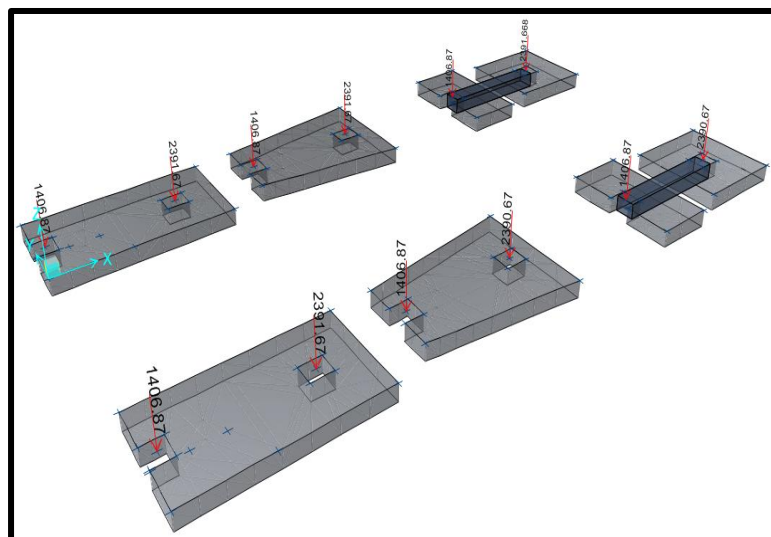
Imagen en planta de los tres tipos de zapata a estudiar modelada en el software
